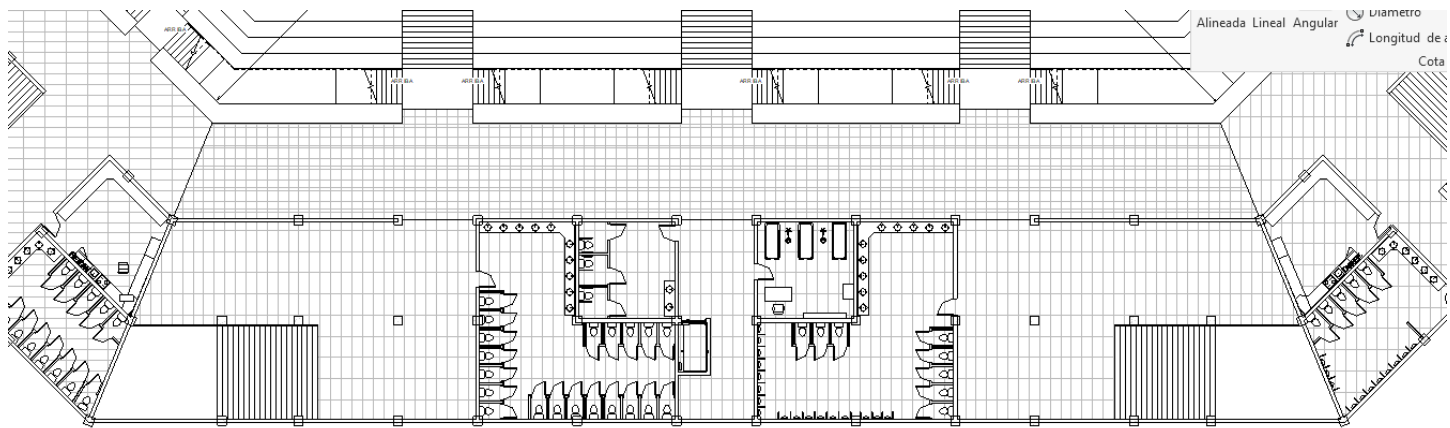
Vista en planta del sector sur del primer piso. Fuente: elaboración propia.
